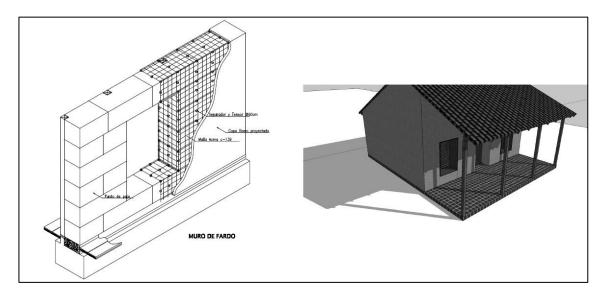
Modelo tipo de la vivienda nueva construida. Fuente: Proyecto reconstrucción EGIS PLANING S.A
